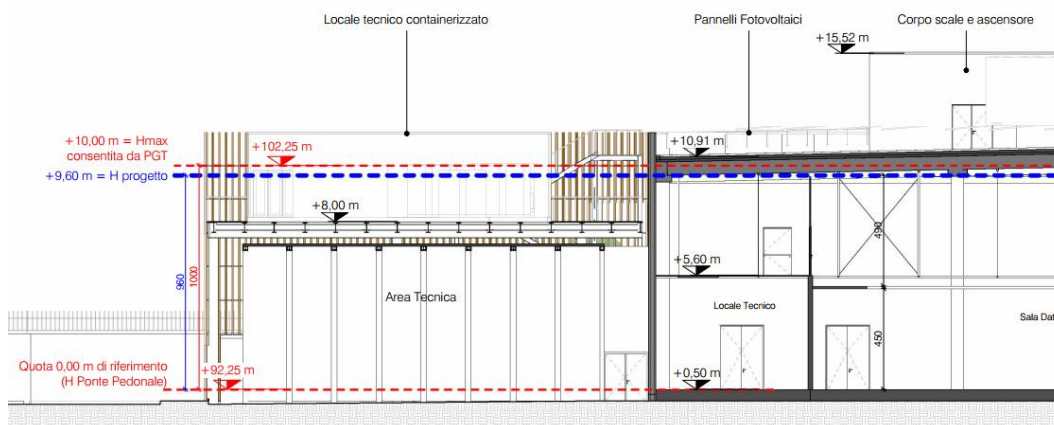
Stralcio sezione di dettaglio – stato di progetto
